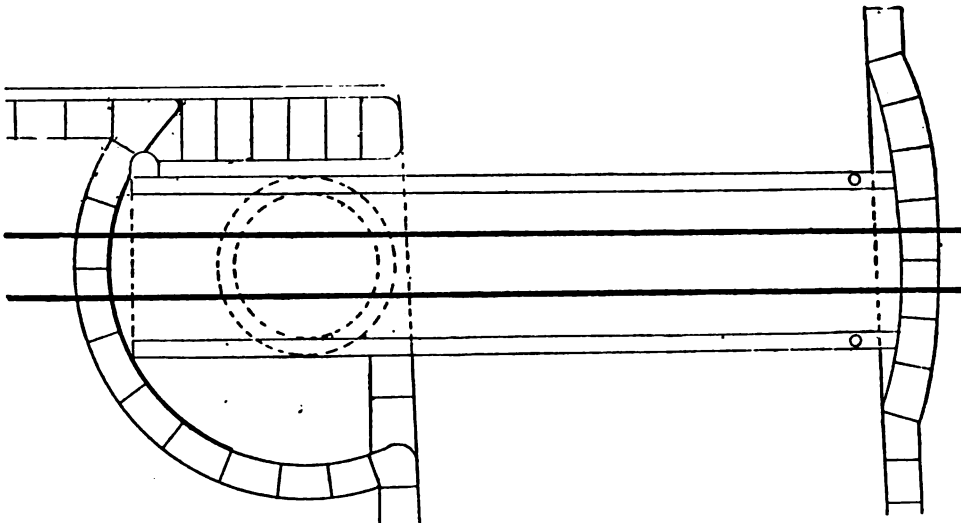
Pont tournant de Whitehaven. — l'lan.
